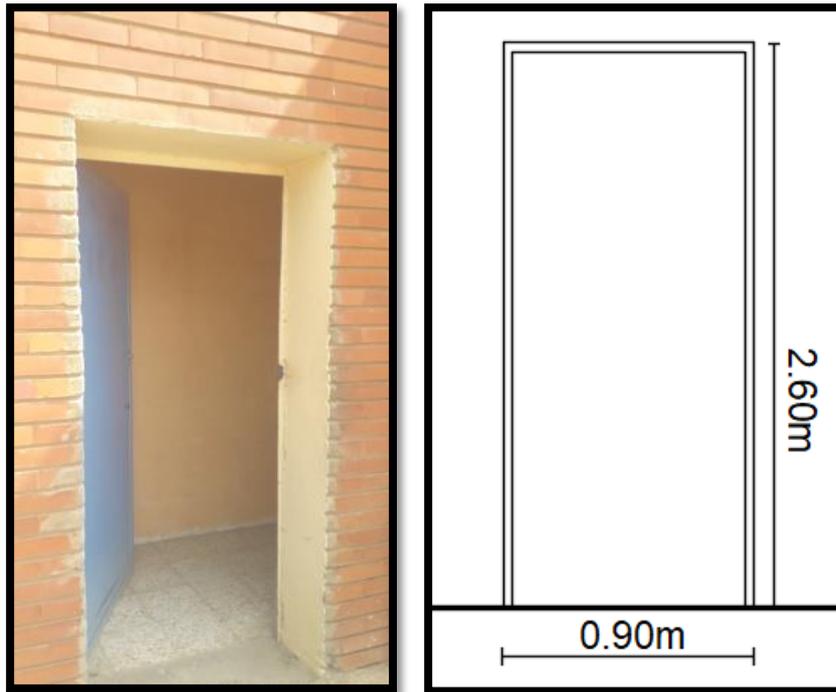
Porte côté cour de la buvette/Source : Dessin Auteur
